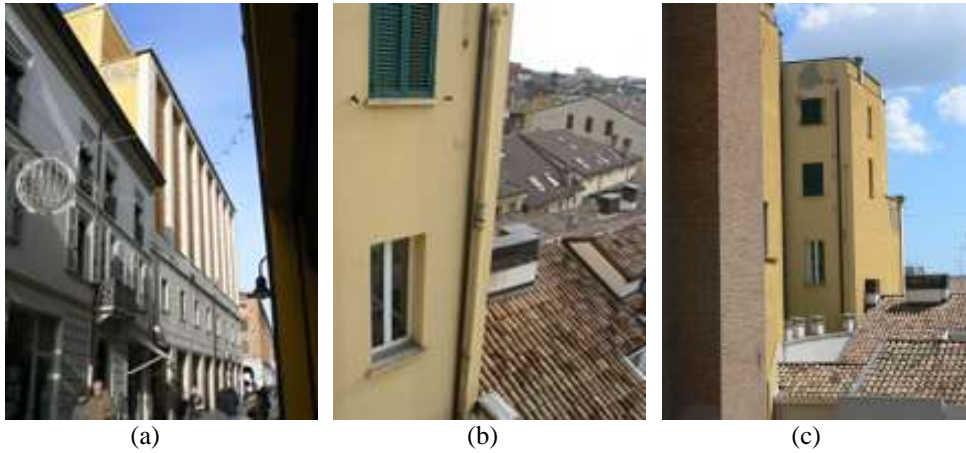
Edifici di minore altezza adiacenti all'edificio in oggetto sul prospetto posteriore.
